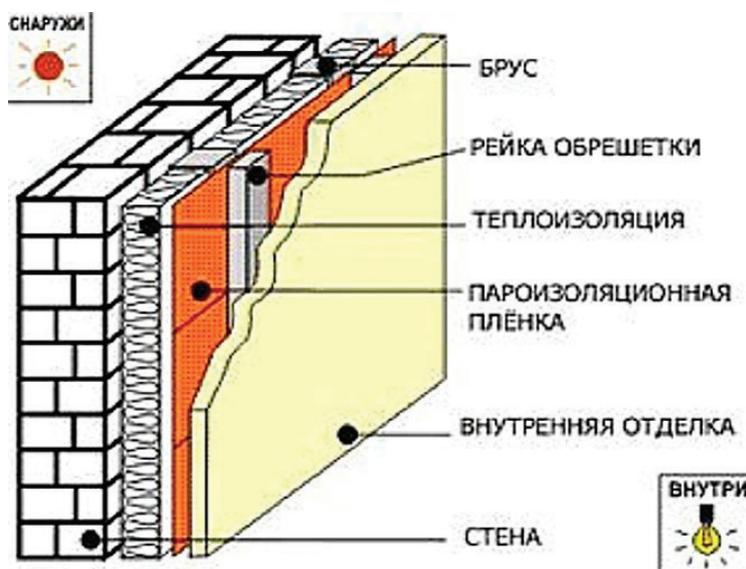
Конструкция наружной стены с внутренней теплоизоляцией
